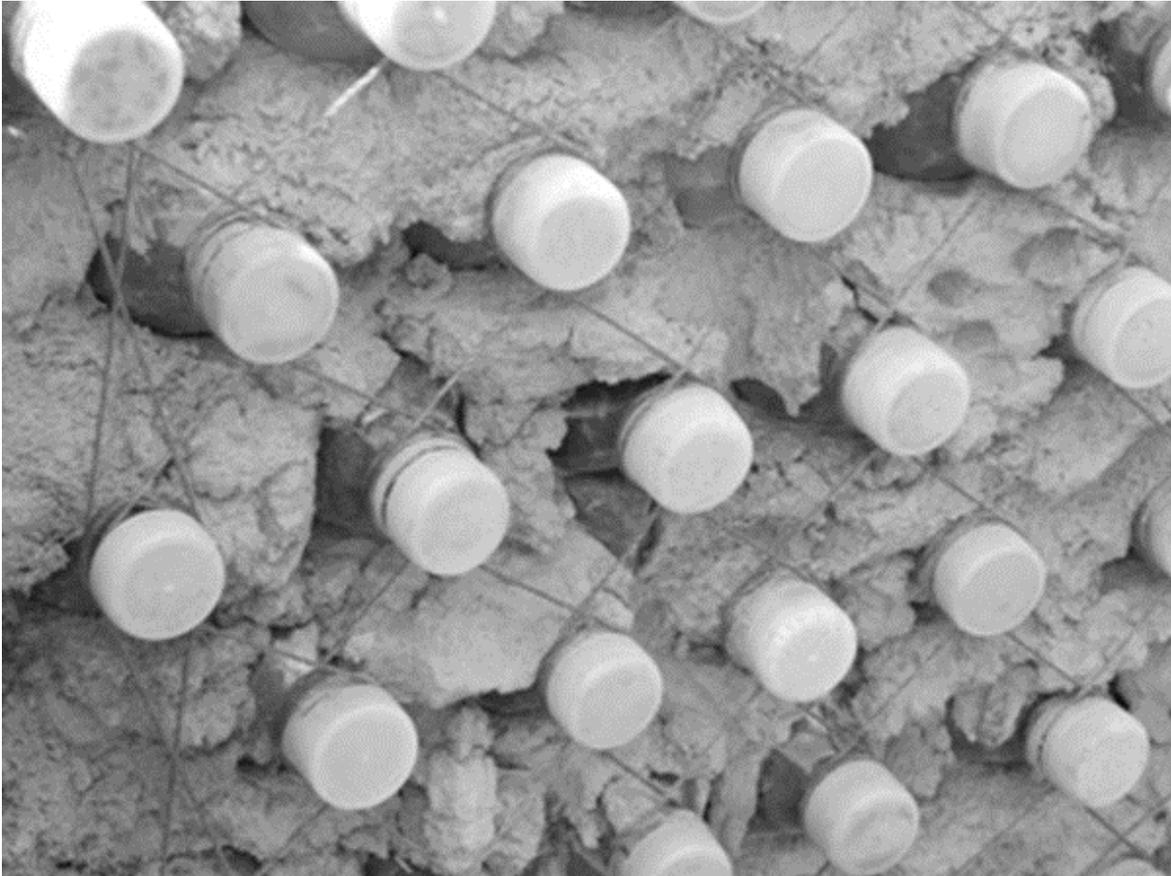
Detalle del armado del muro de la cisterna.
